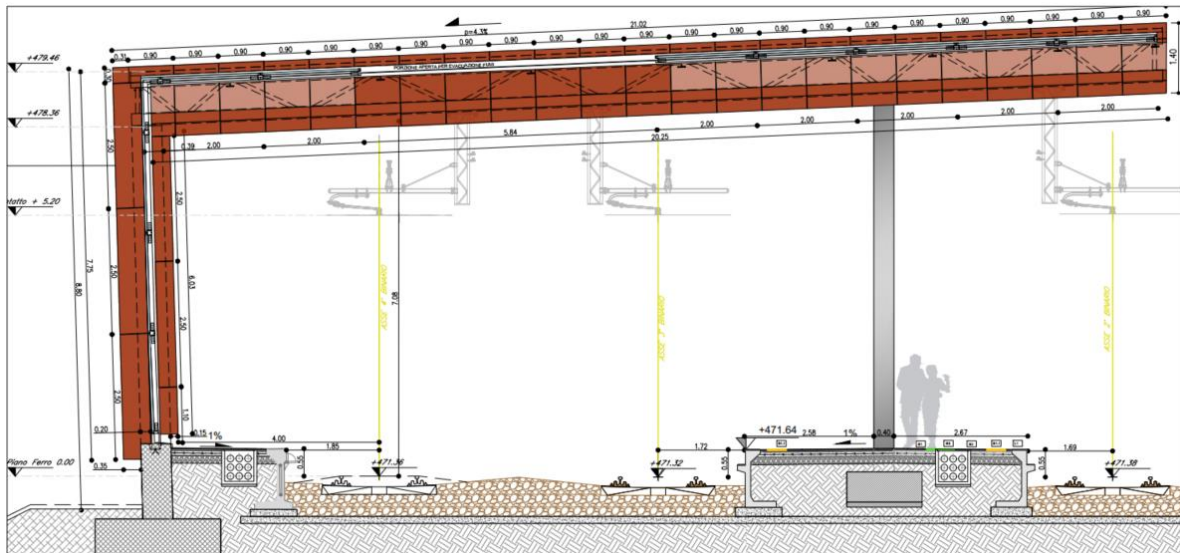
Sezione trasversale copertura stazione con rivestimento Tipo V2
